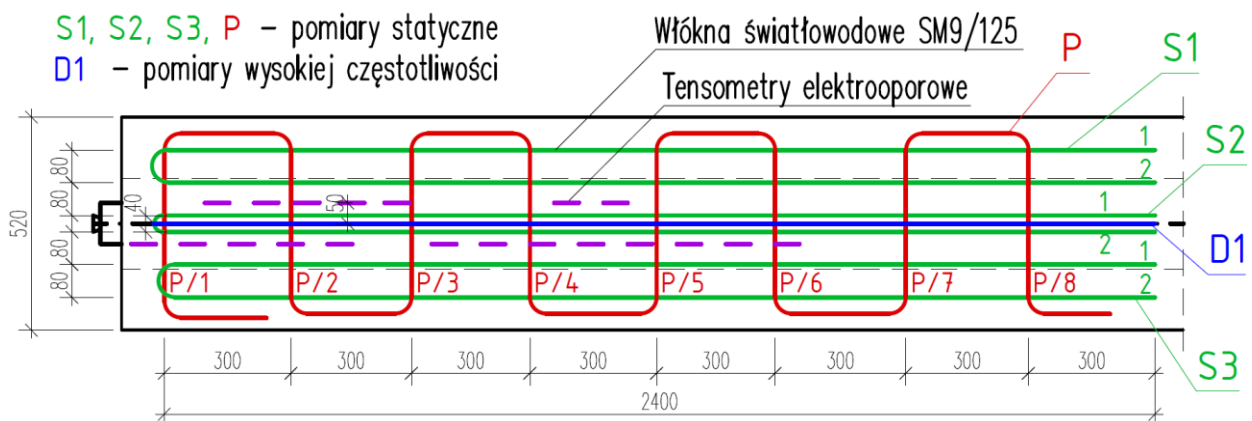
Schemat elementu badawczego do badań długości transmisji siły sprężającej – odcięcie zakotwień dolnych kabli sprężających (typ 2).
